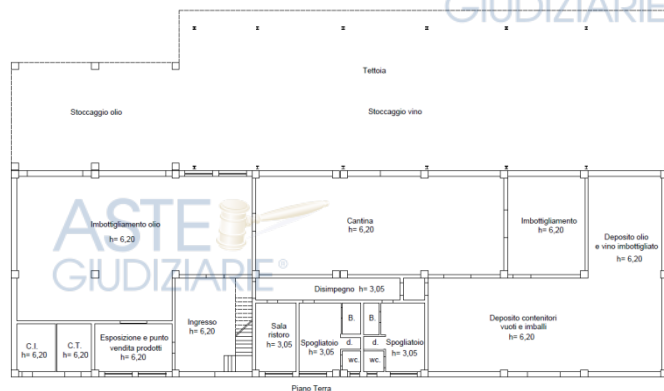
Planimetria rilevata del piano terra dell'opificio con indicazione delle destinazioni d'uso (non in scala)
